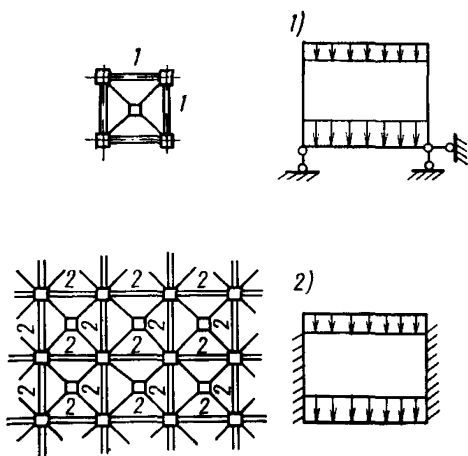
Расчетные схемы вертикальных стенок высоких бункеров при расчете на общий изгиб
